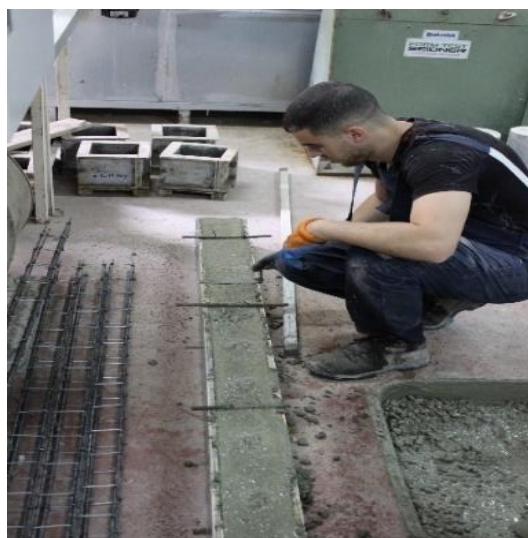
Ferrailage des poutres (dimensions en mm).
